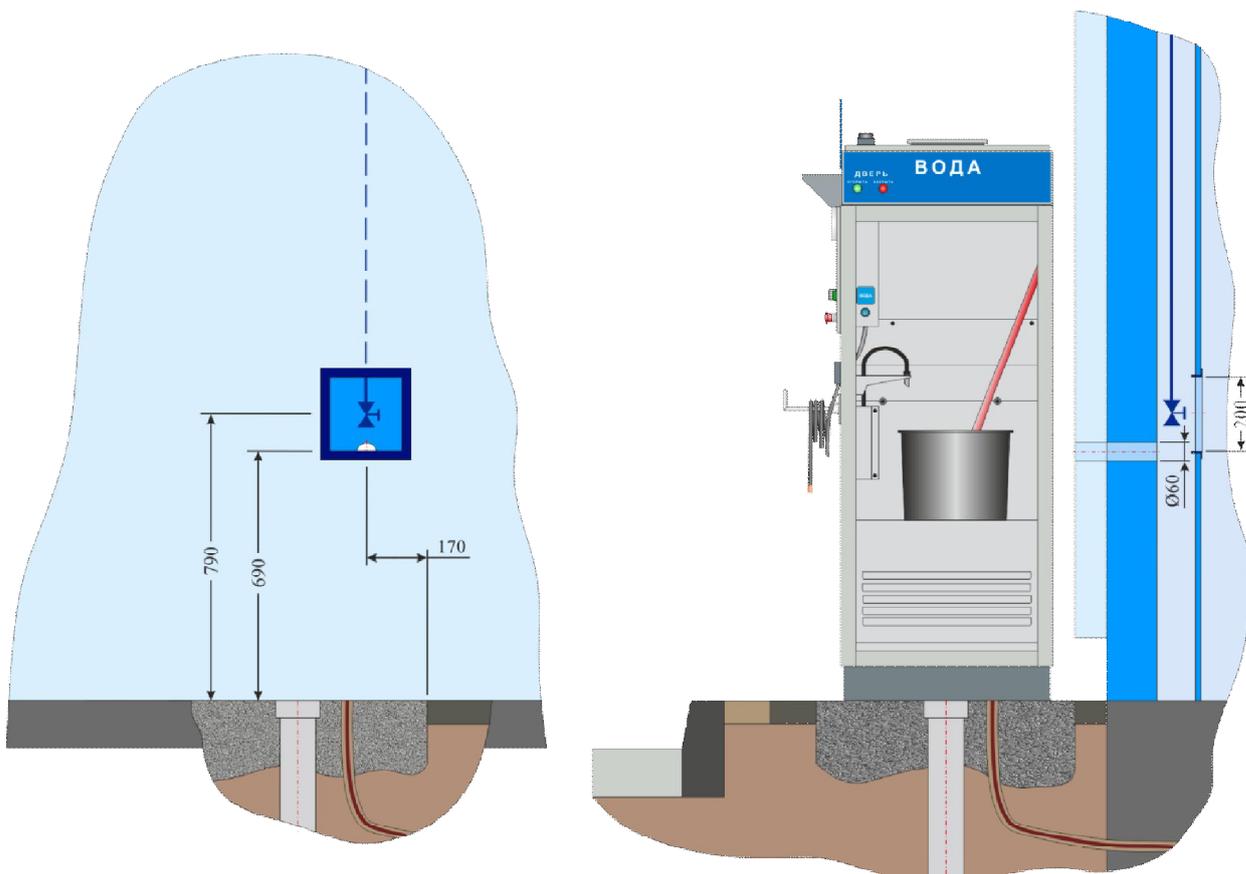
Схема размещения запорной арматуры за внутренней отделкой стены здания АЗС (слева – вид изнутри помещения АЗС)
